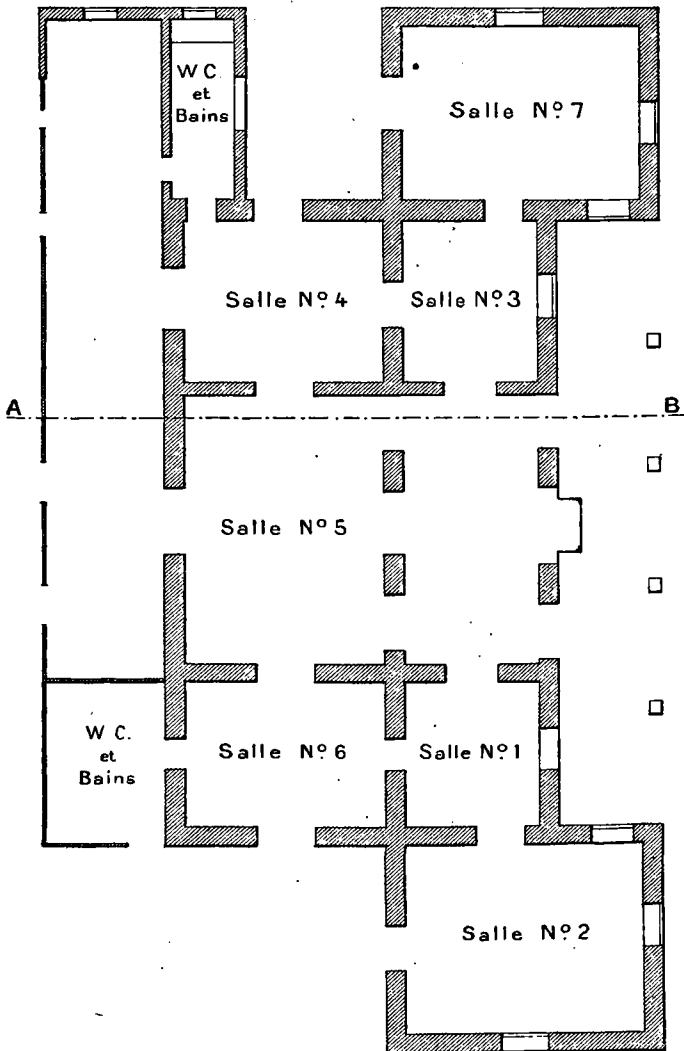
Plan du pavillon de la fièvre jaune à l'hôpital de Las Animas, à La Havane. Echelle de 1 pour 200.
